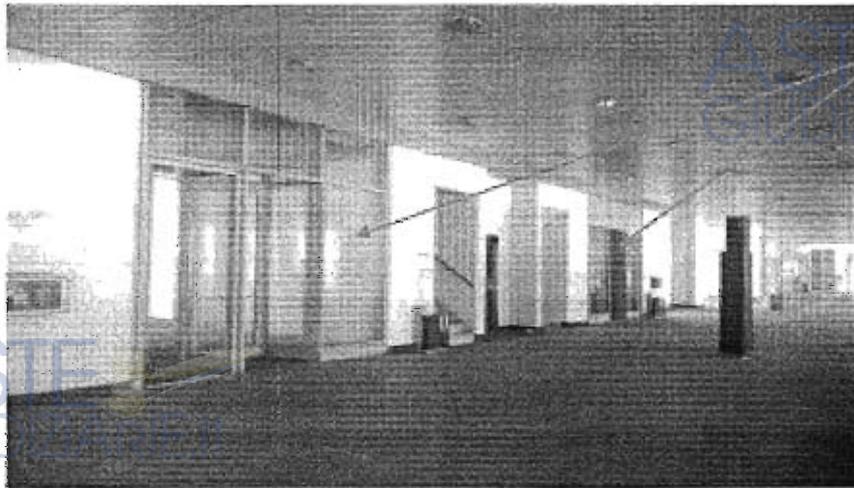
(P. Terra, vista dalla promenade ingresso banche, sub 143 e 142)
